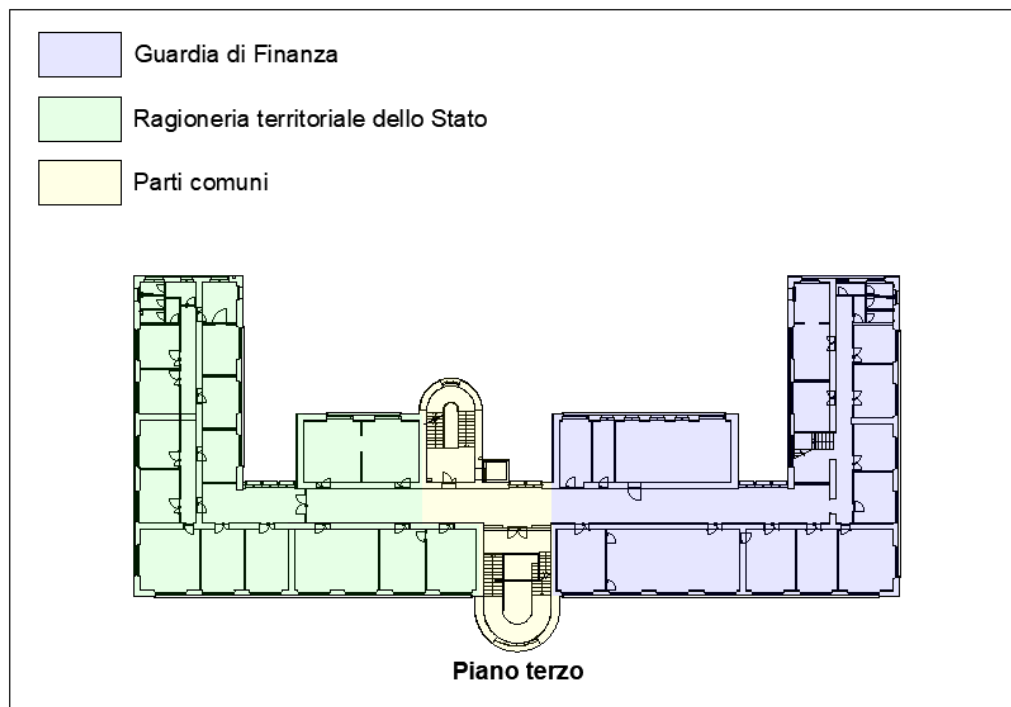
Pianta piano terzo: piano di razionalizzazione e future Amministrazioni utilizzatrici
